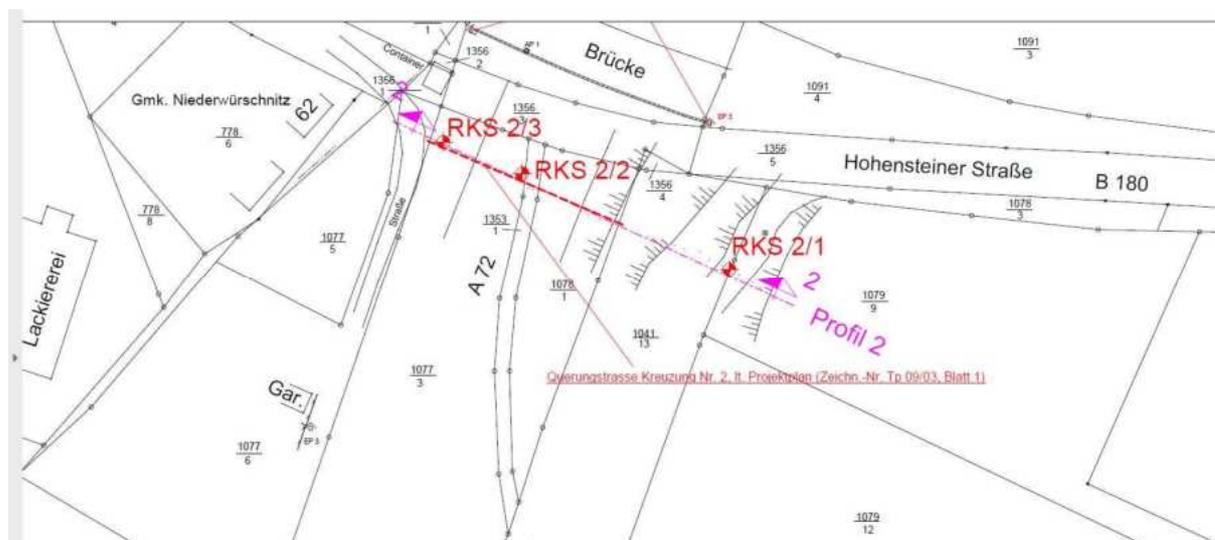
Planausschnitt der Baugrunduntersuchungen (IB Eckert 05/2003)
